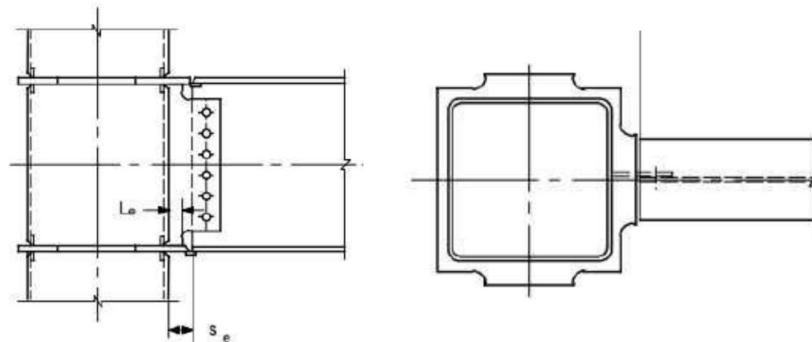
4- Conexión con diafragma pasante para aplicación de soldadura en obra [16]
